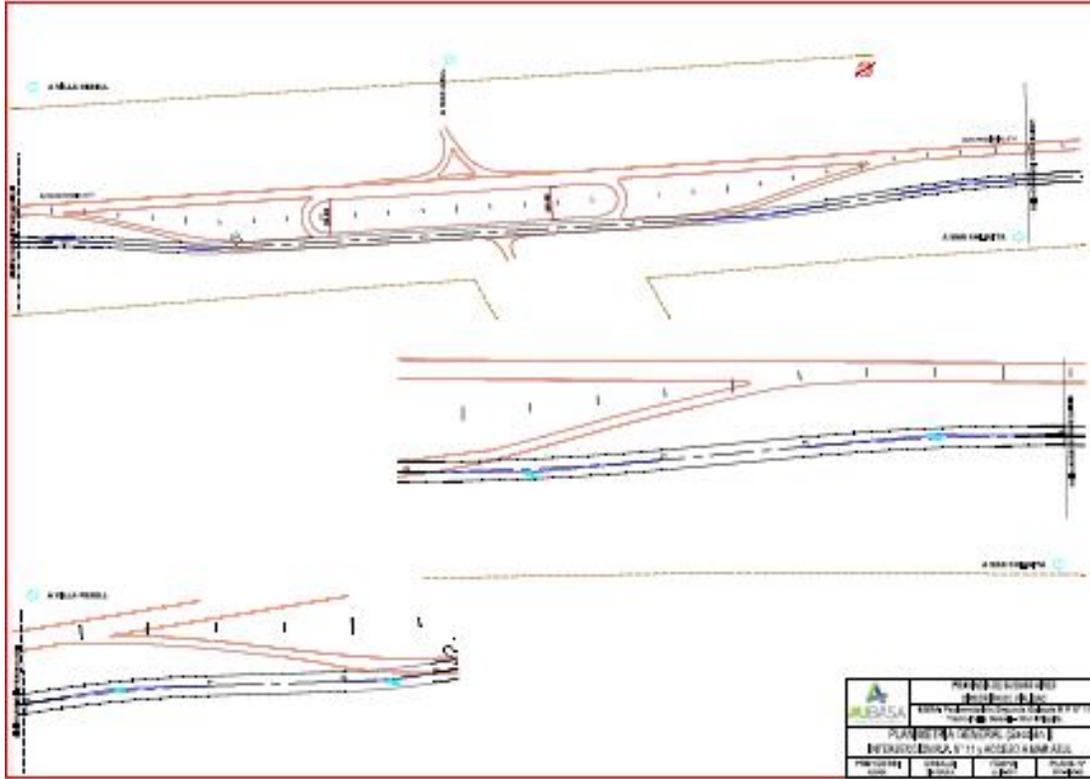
Planimetría Intersección RP N°11 y Acceso a Mar Azul
